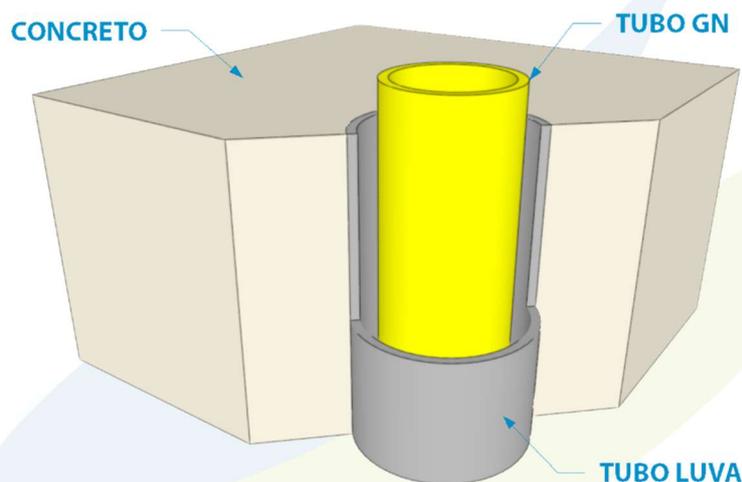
d. Tubo-luva - Passagem em elemento estrutural
